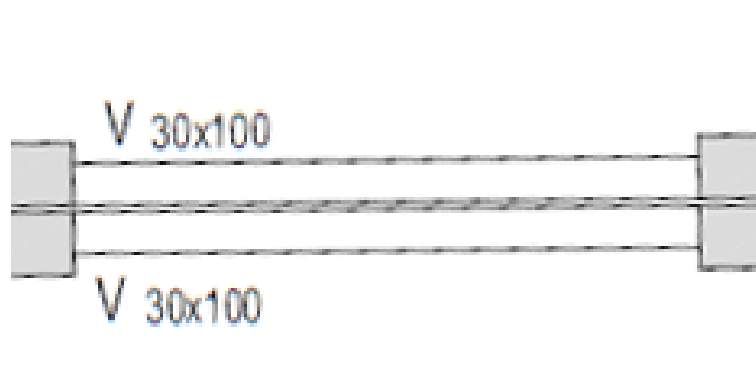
DETALHE TÍPICO DAS VIGAS - EIXOS E6 E14
